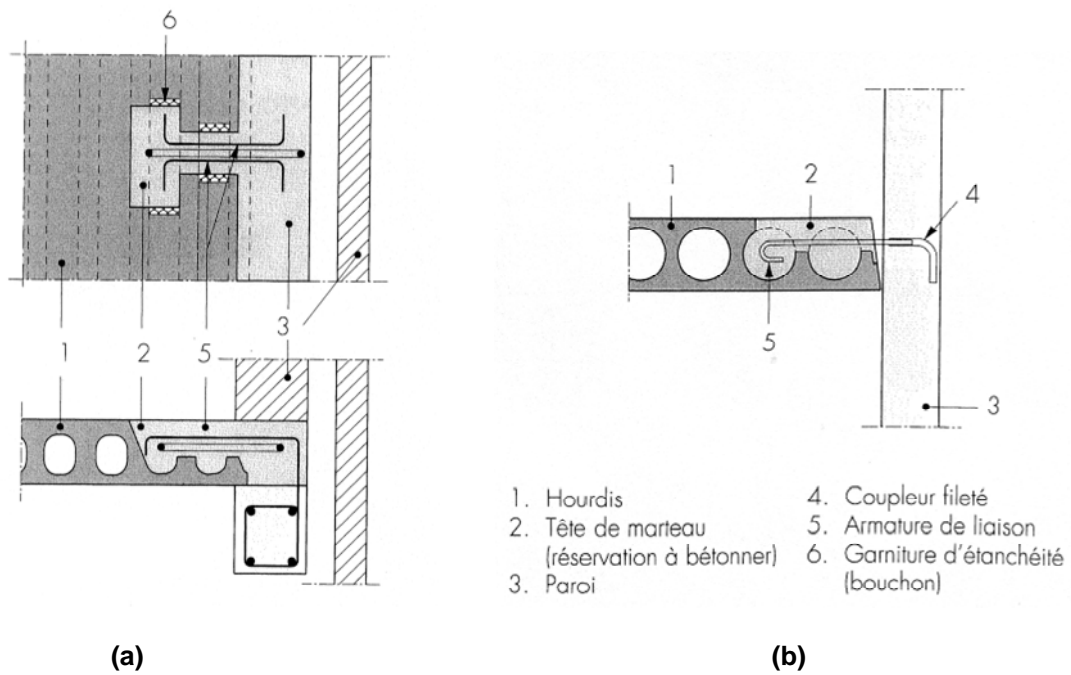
(a) tête de marteau, coupe et vue en plan (b) coupleur fileté, coupe (CSTC, 2002)
